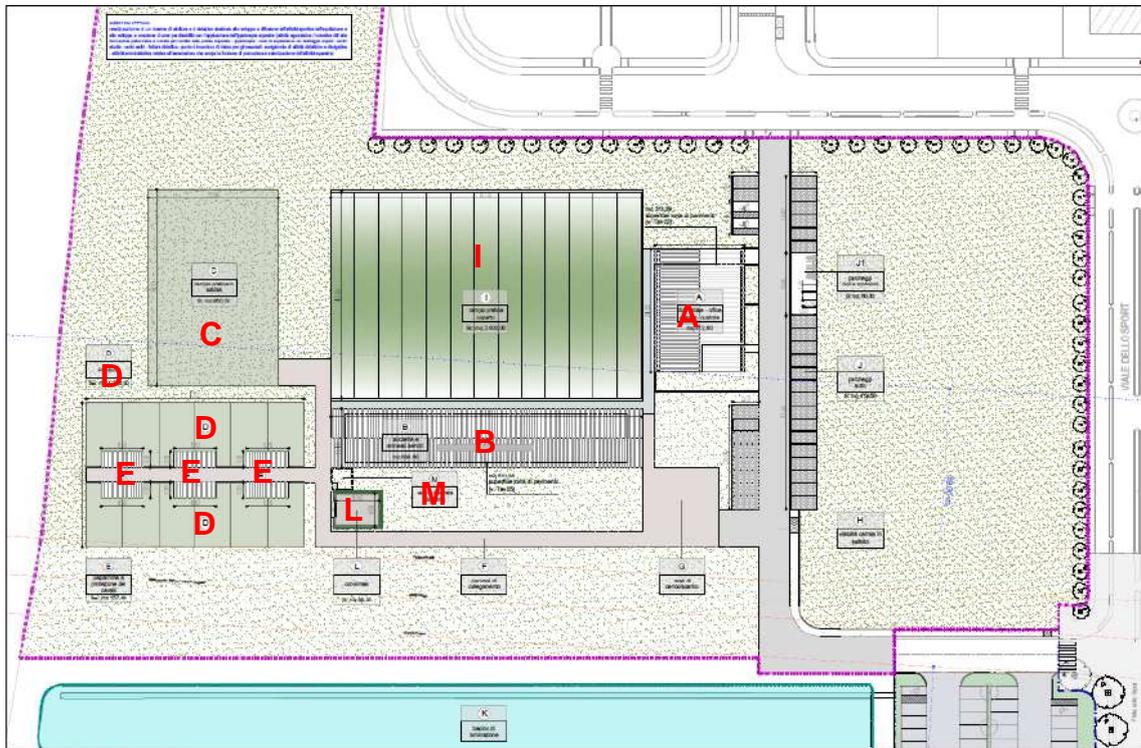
Planimetria di dettaglio del nuovo Centro Ippico in Comune di Saccolongo (tav 02-aprile 2020)
